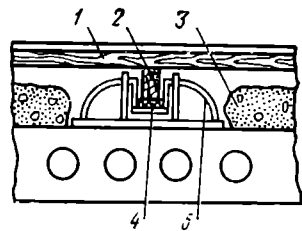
Конструкция плавающих полов: 1 — дощатый пол; 2 — деревянная лага; 3 — шлаковата; 4 — упругая прокладка; 5 — пружина
